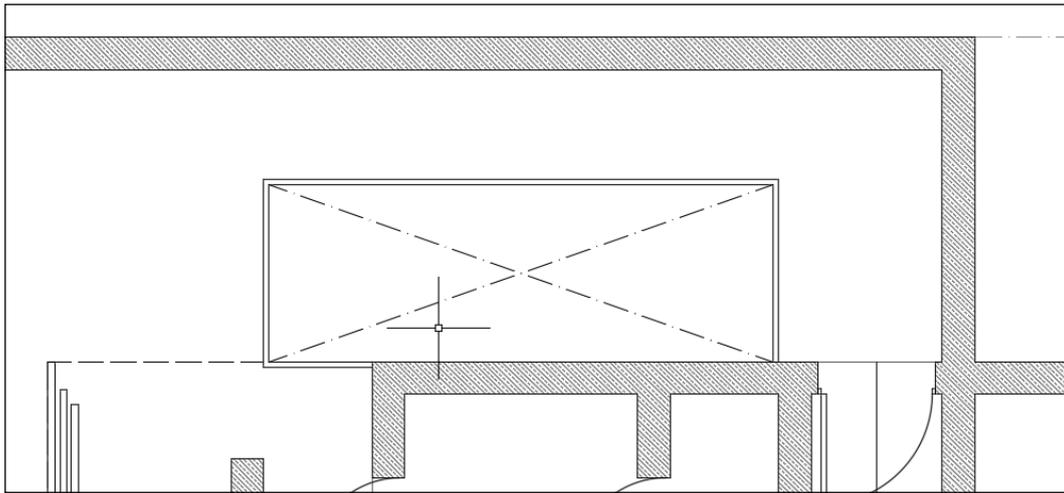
Jardinera del Garaje con salida ventilada al exterior vista desde la planta Baja.
